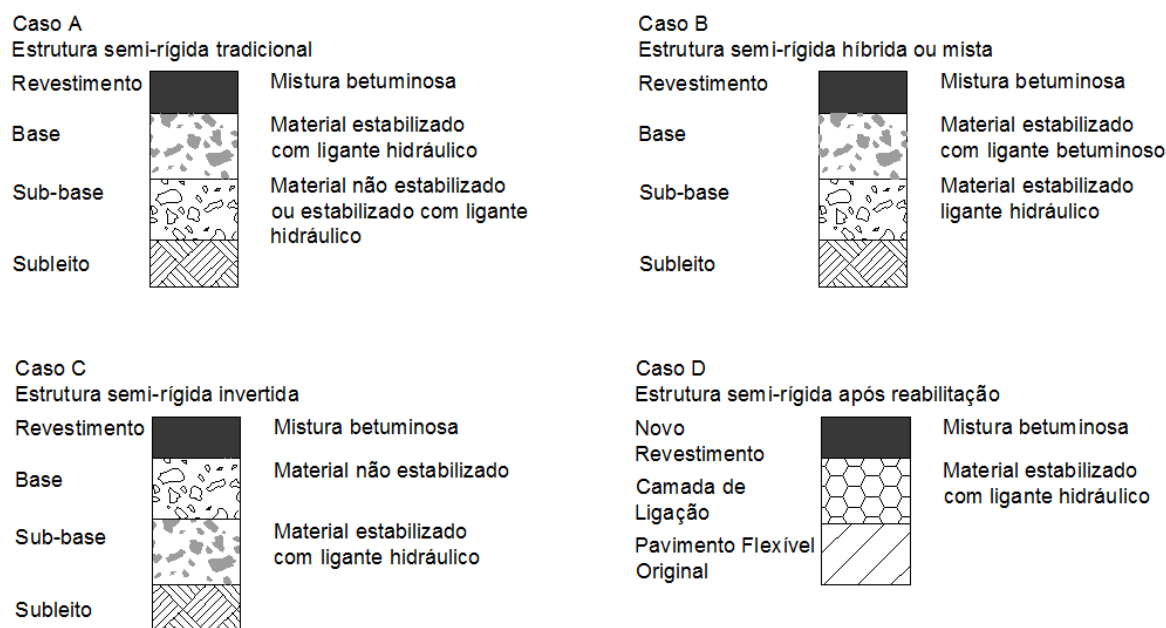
tipos de pavimento semi-rígido (BALBO, 2007, p. 52)
